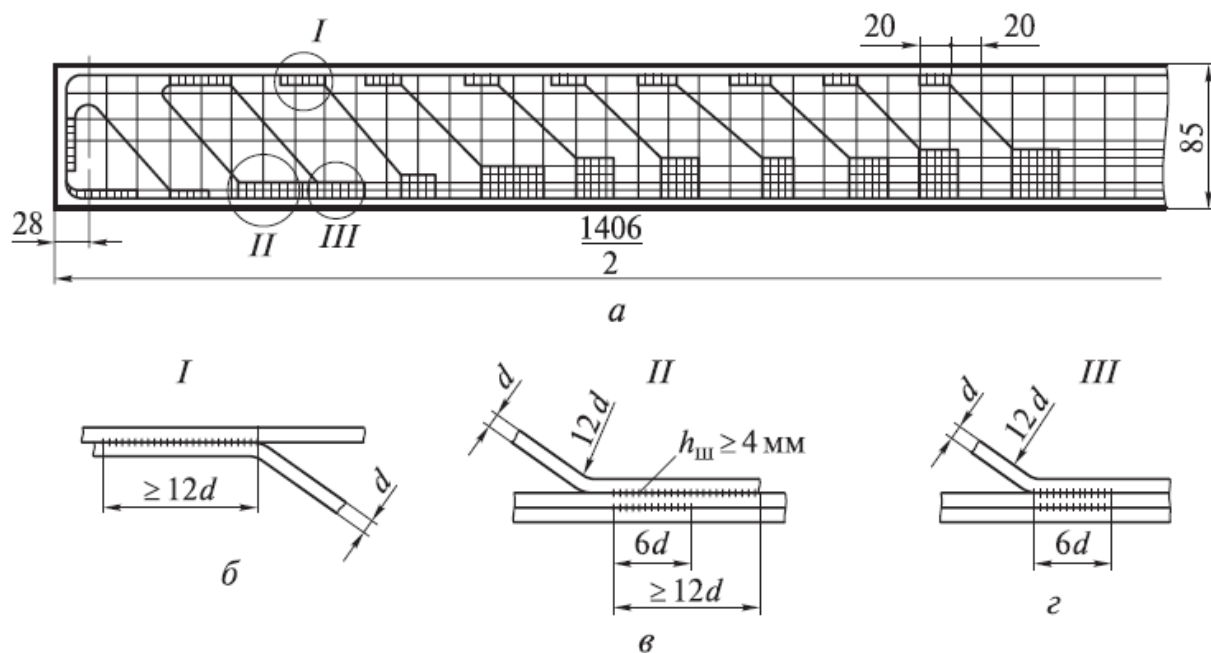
Общий вид сварного каркаса (а) и конструкции его узлов I, II и III (б—г)
